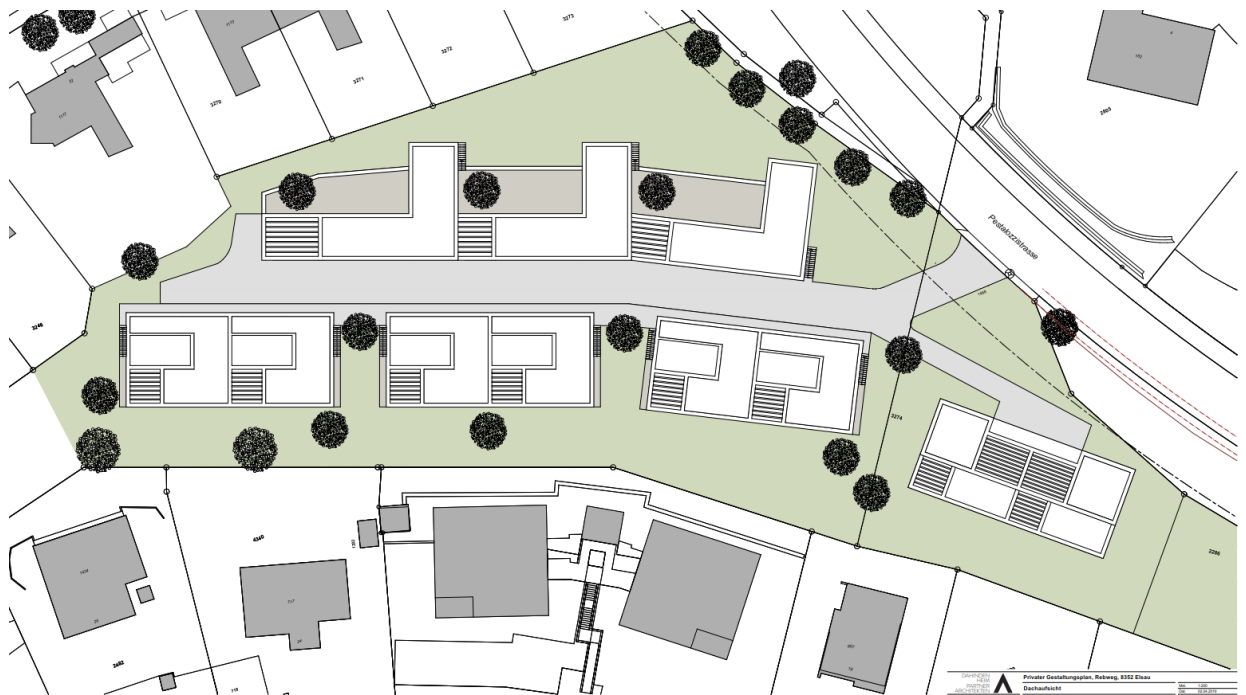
Bebauungskonzept Rebweg, Dachaufsicht
